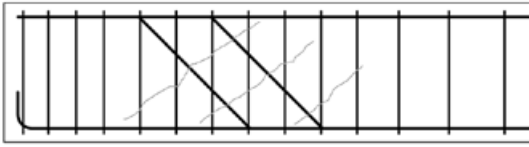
Tendenziell sich einstellende Schubrisse in einem Biegebalken (Schemadarstellung: JR).
